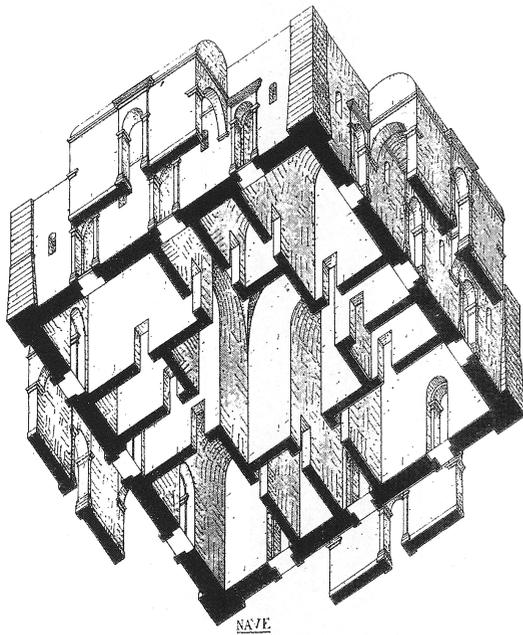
Kaláthenes, Villa Retonda, Grundriss (aus: Bosineki-Didoni, Kreta [wie Anm. 16], S. 43).
